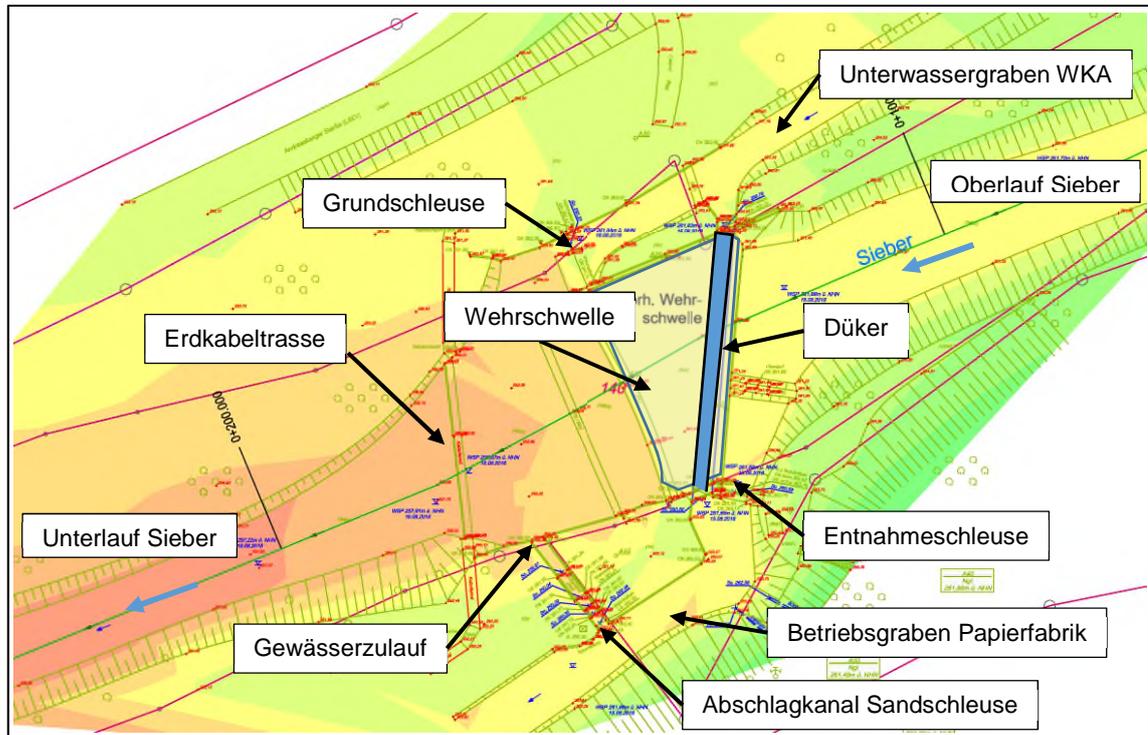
Vermessungslageplan Wehr Sieber V (vgl. Zeichnung 40.6)
